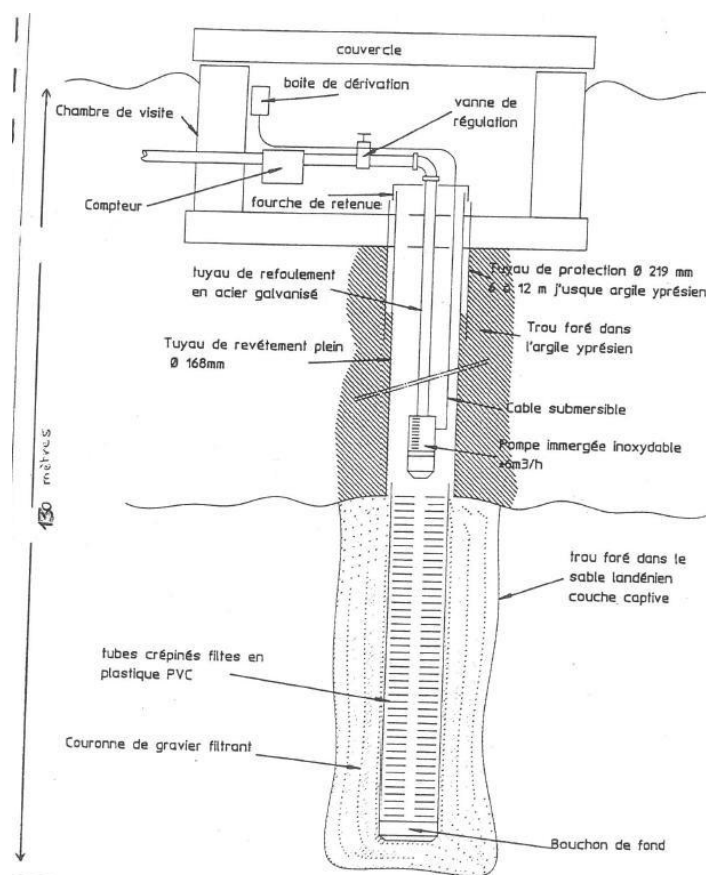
coupe du forage prévu sur le site de la SARL HAMEZ
